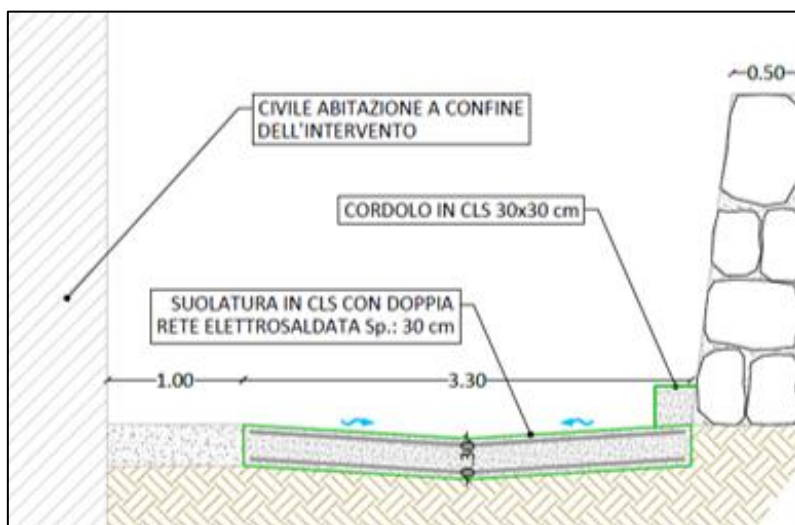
Sezione tipo opera in progetto del secondo tratto dell'Intervento A.
